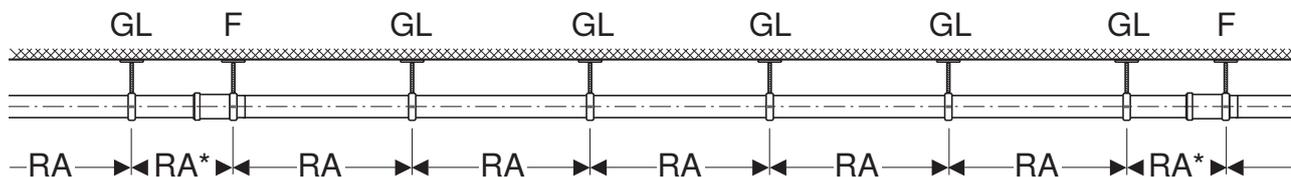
Расстояния между хомутами RA при креплении на потолках и горизонтальном креплении на стенах, без направляющих опорных желобов
